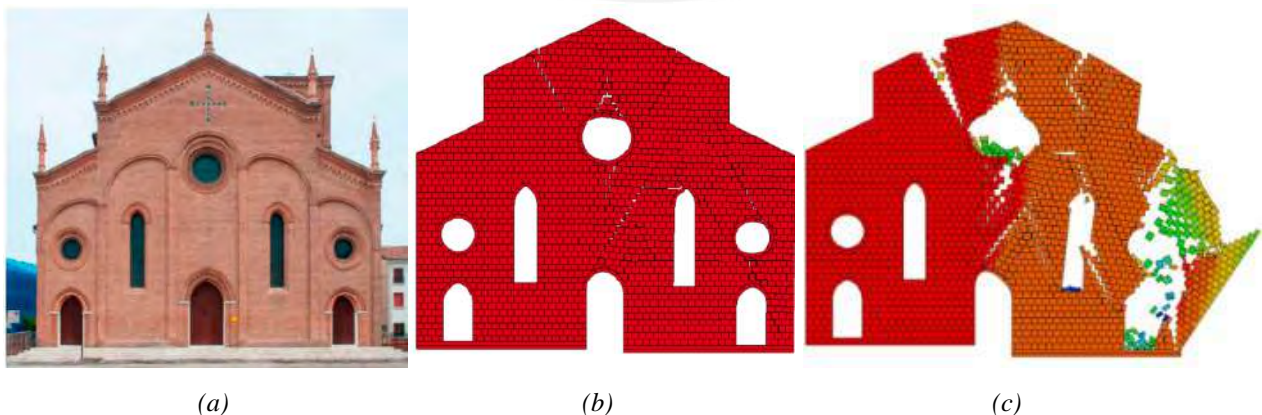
Ensayo de asentamiento en fachada de parroquia (Ou et al., 2022)
